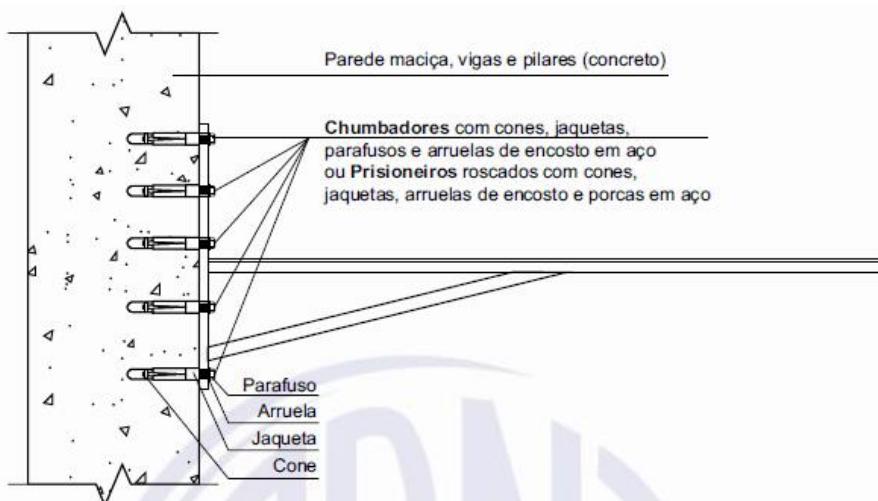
Exemplo de fixação de suporte tipo mão-francesa em base de concreto armado
